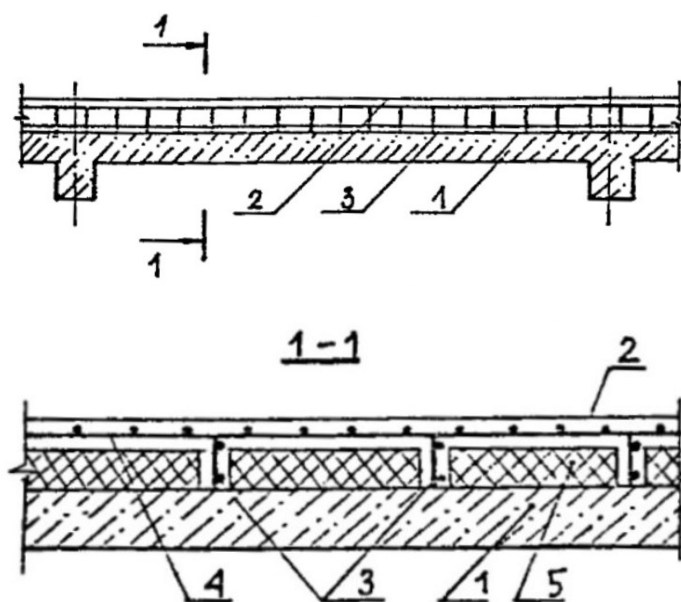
Збільшення несучої здатності плити перекриття нарощуванням зверху з пустотоутворювачами: 1 – плита перекриття, яка підлягає підсиленню; 2 – ребриста плита з моноліту, яка додається; 3 –каркаси нарощування з арматури; 4 – додаткові арматурні сітки; 5 – пустотоутворювач (пінопласт, пінополістерол тощо)
